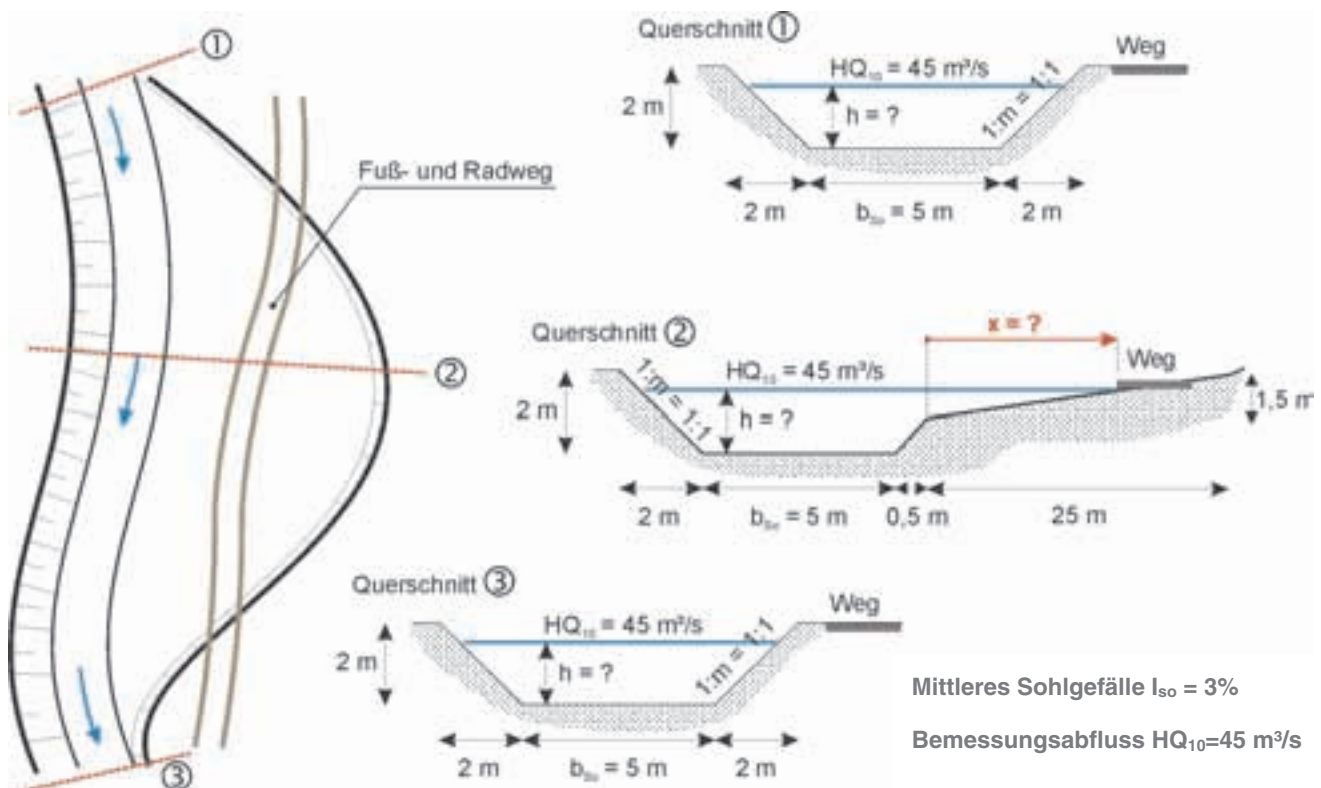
Grundriss und Querschnitte zur geplanten Maßnahme.
